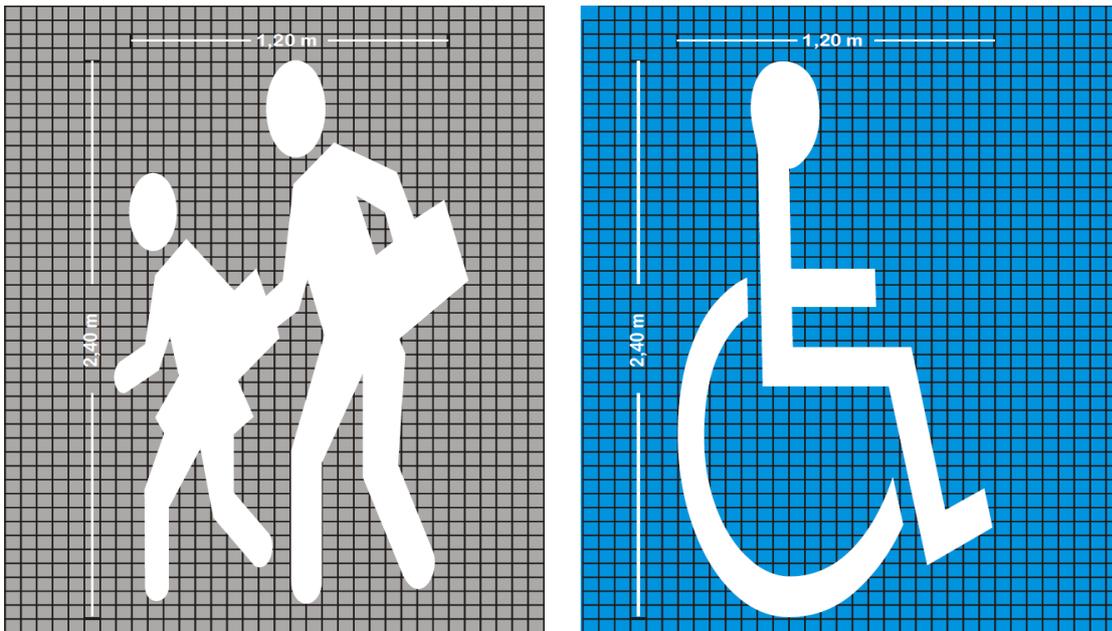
SÍMBOLOS EN EL PAVIMENTO
